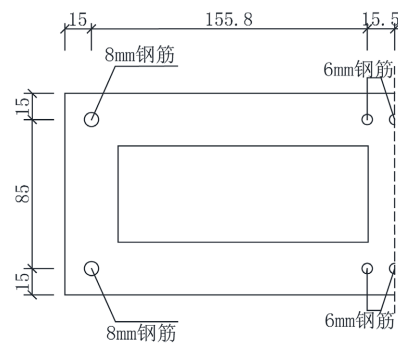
Reinforcement layout of half pier column with 6 mm and 8 mm bars
